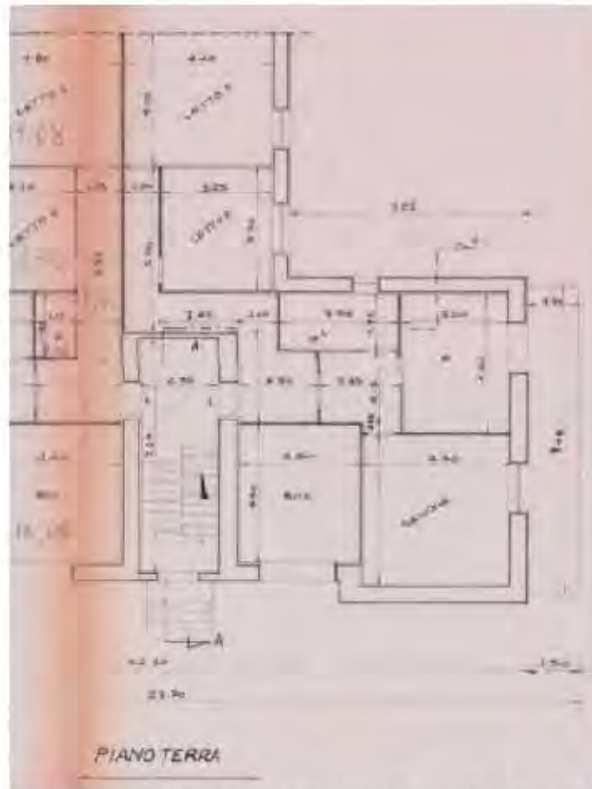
Planimetria edilizia legittima appartamento al piano terra con adiacente locale box (19.3.1998)
